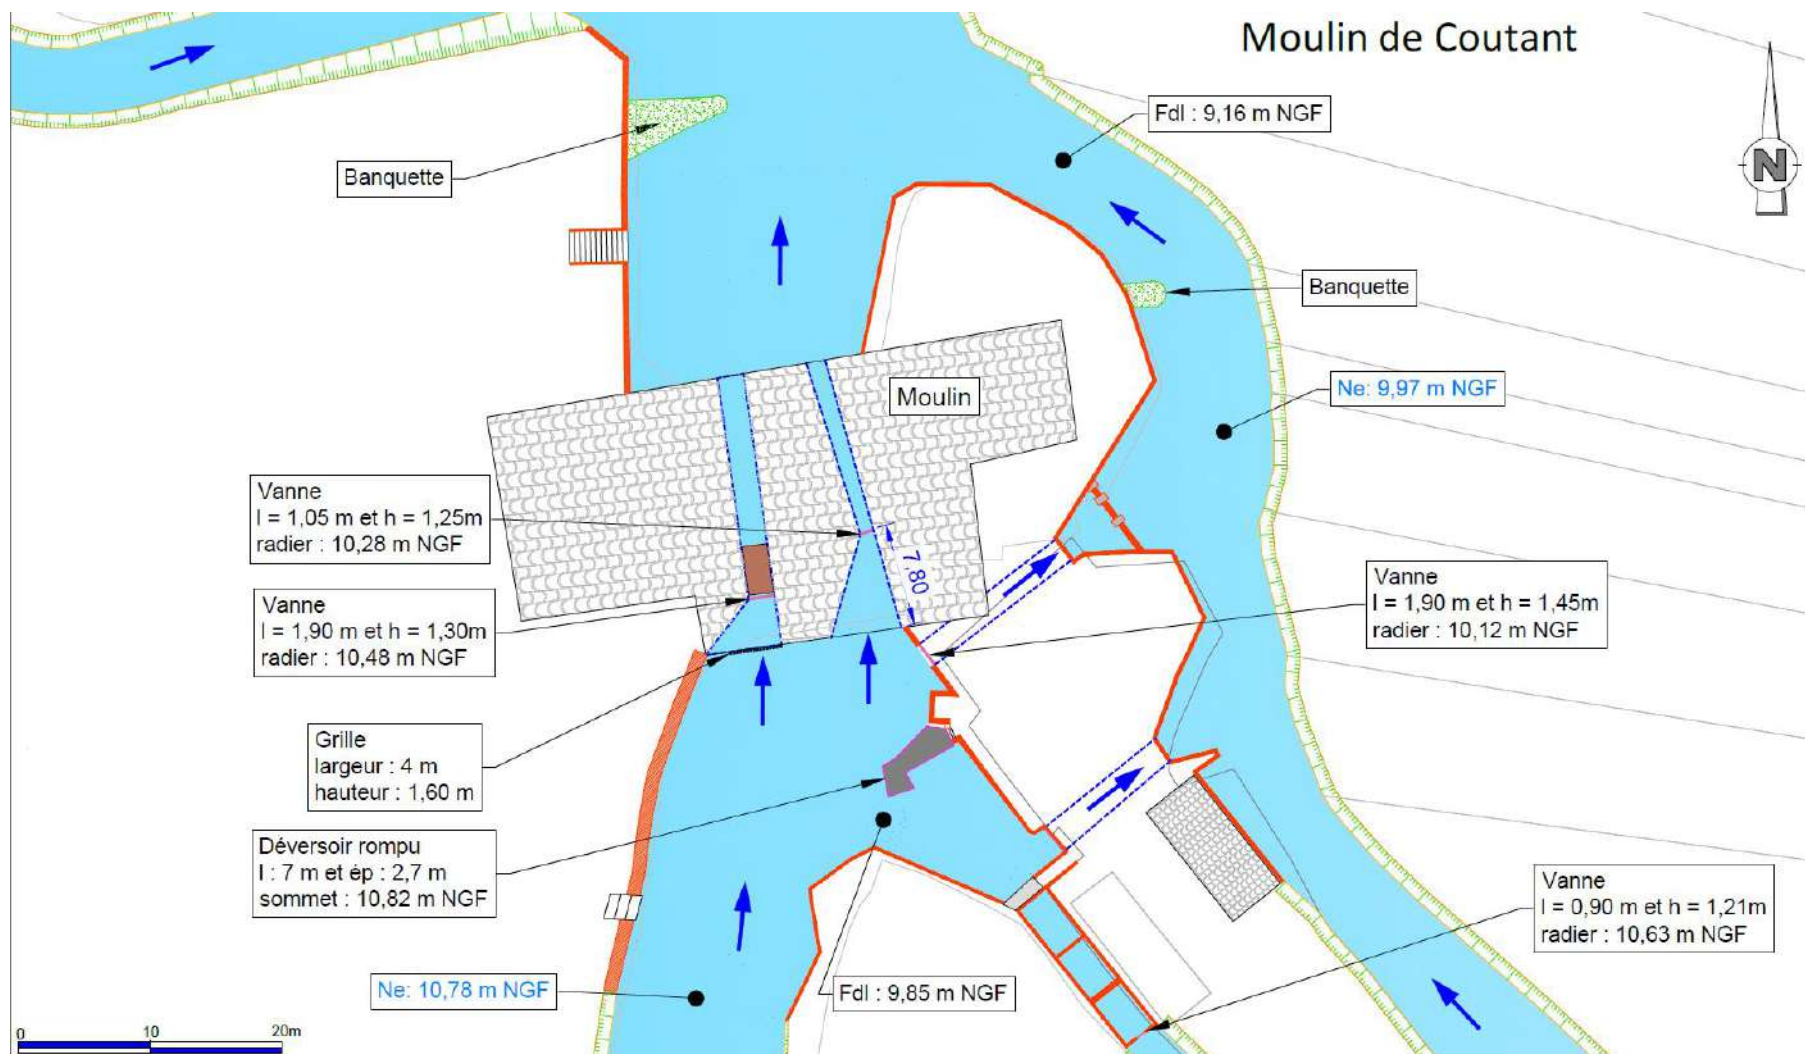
Vue en plan des ouvrages hydrauliques du site du Moulin Coutant
